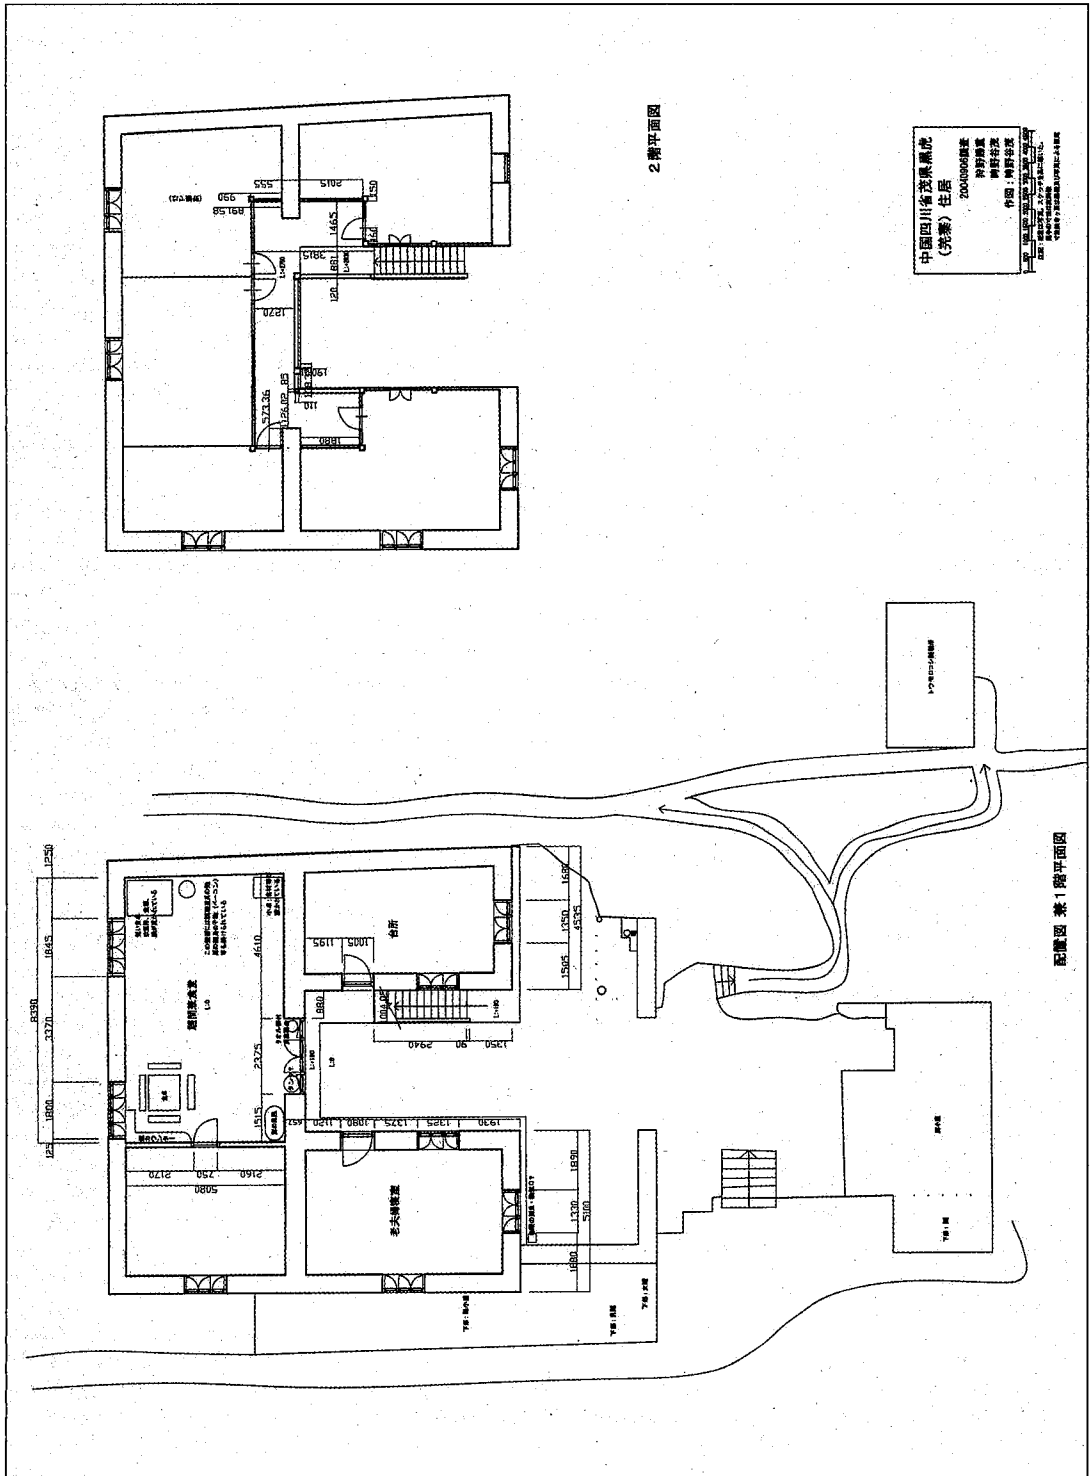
：黒虎羌寨 楊宅配置図・平面図（調査：狩野勝重、時野谷茂 作図：時野谷茂）
